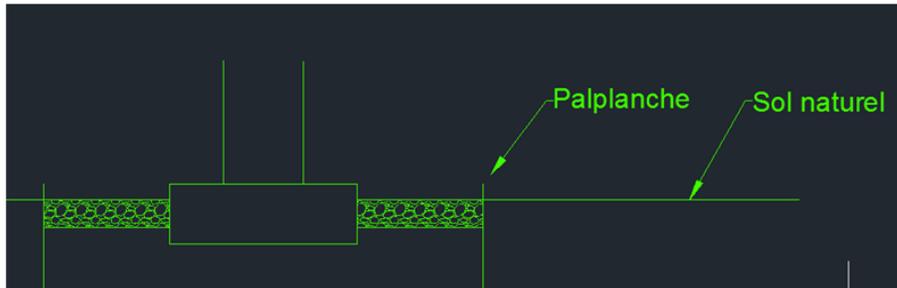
Schéma d’enrochement des semelles confiné à l’intérieur des batardeaux prévu autour des semelles des piles 4, 5, 7, 8, 9, 10 et 11 du pont Charles-De Gaulle (croquis technique)
